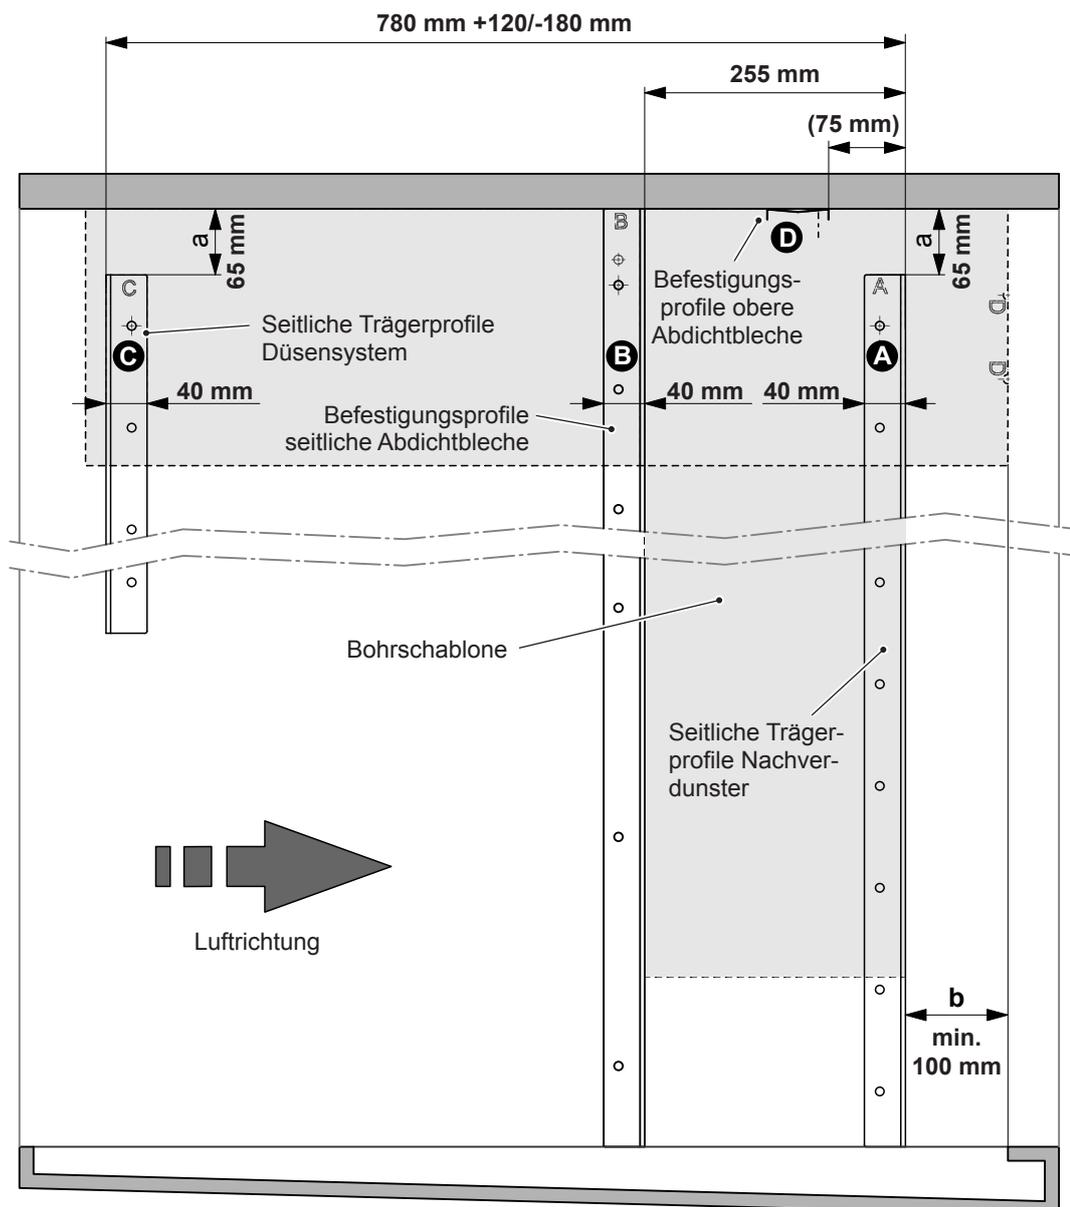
Positionierung der Befestigungselemente (Seitenansicht)
